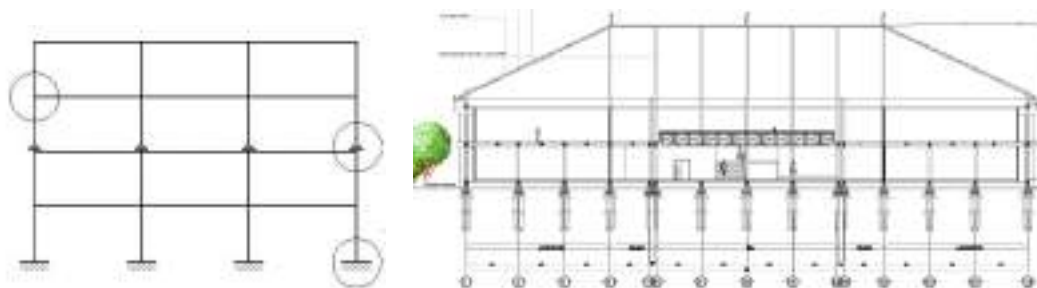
18 Konsep pondasi Batu Kali dan Footplate
